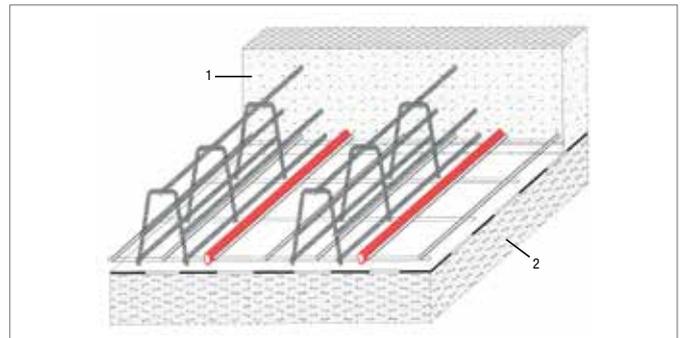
Piano di fondazione in cemento armato con reti in acciaio; costruzione speciale con tubi di riscaldamento montati al centro del piano di fondazione
